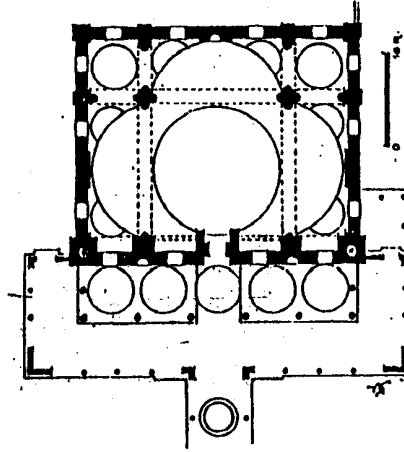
مسقط أفقي لجامع احمد بك اورنوس في يانيس فردار باليونان
